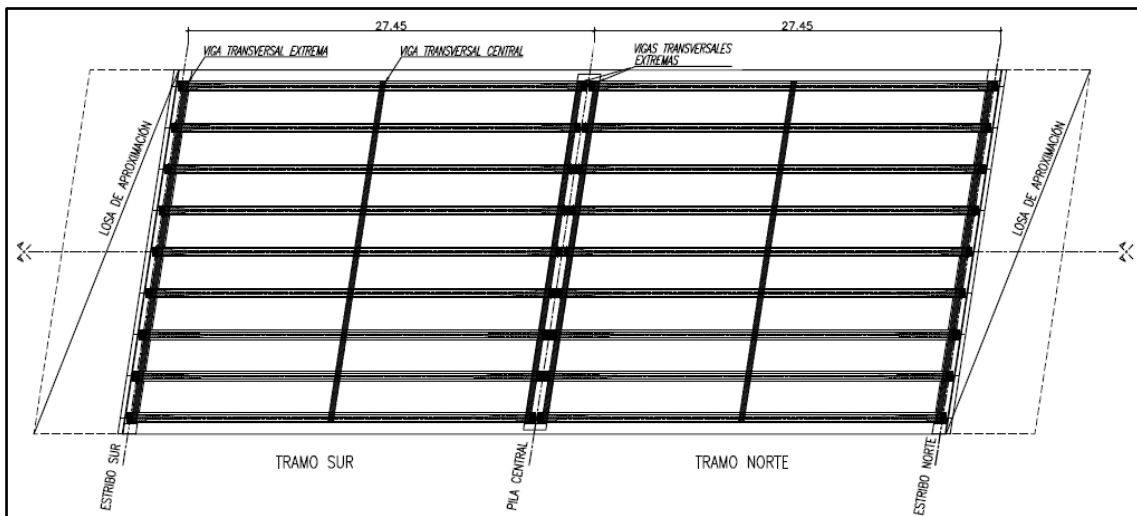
Emparrillado formado por las vigas principales y transversales
